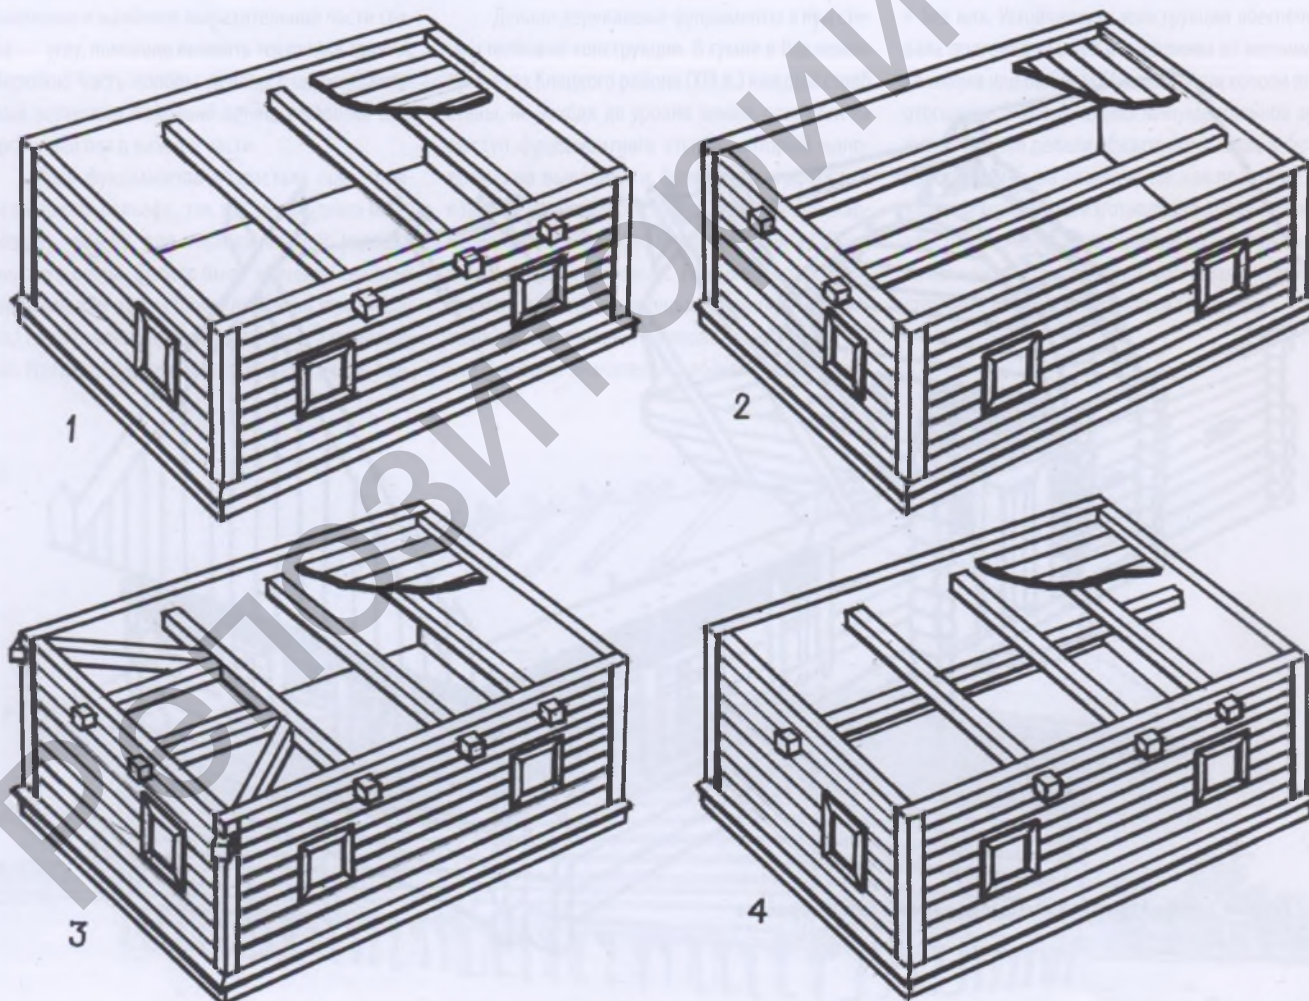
Типы плоских перекрытий в жилых домах:
